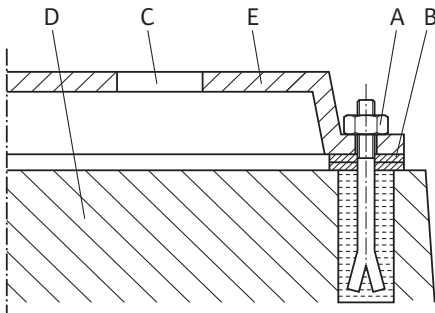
Voorbeeld voor een fundament-draadaansluiting
